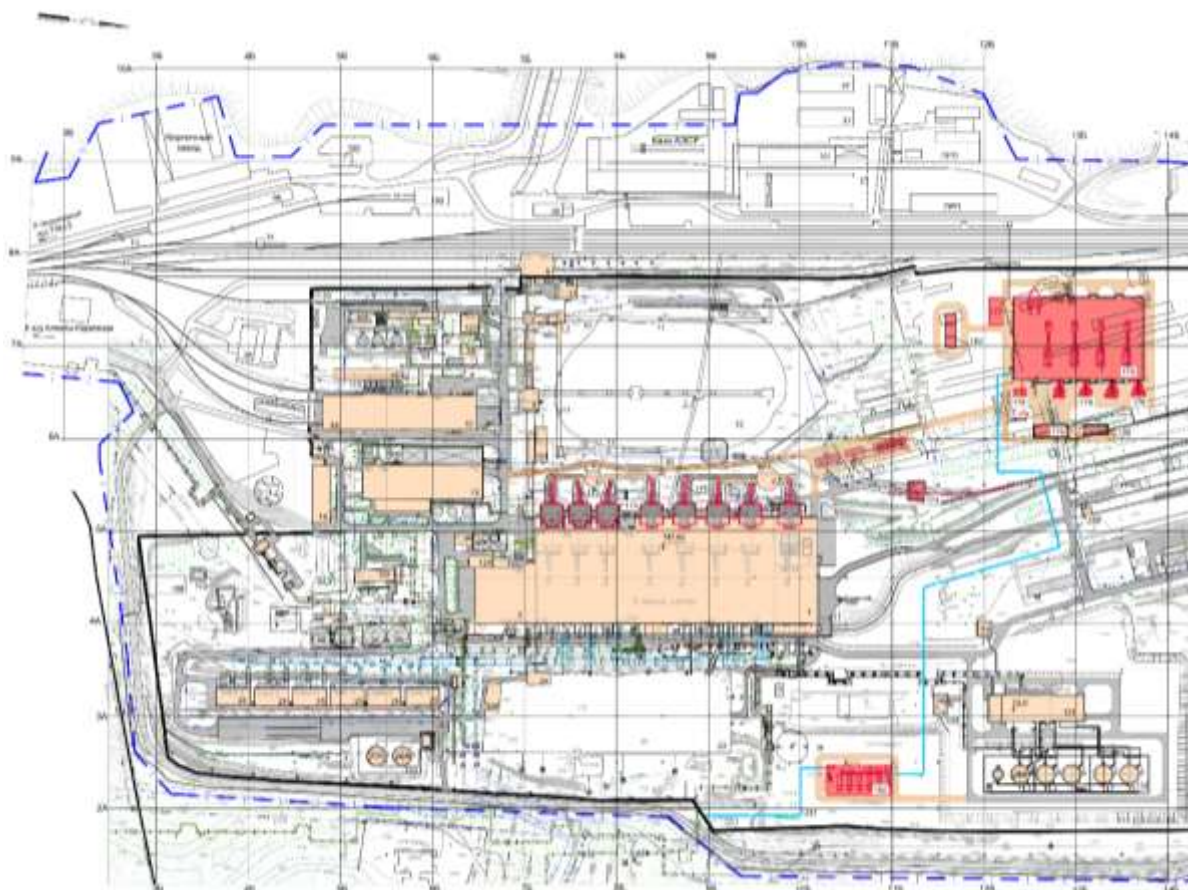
Вариант 4. Схема генерального плана ТЭЦ-2
